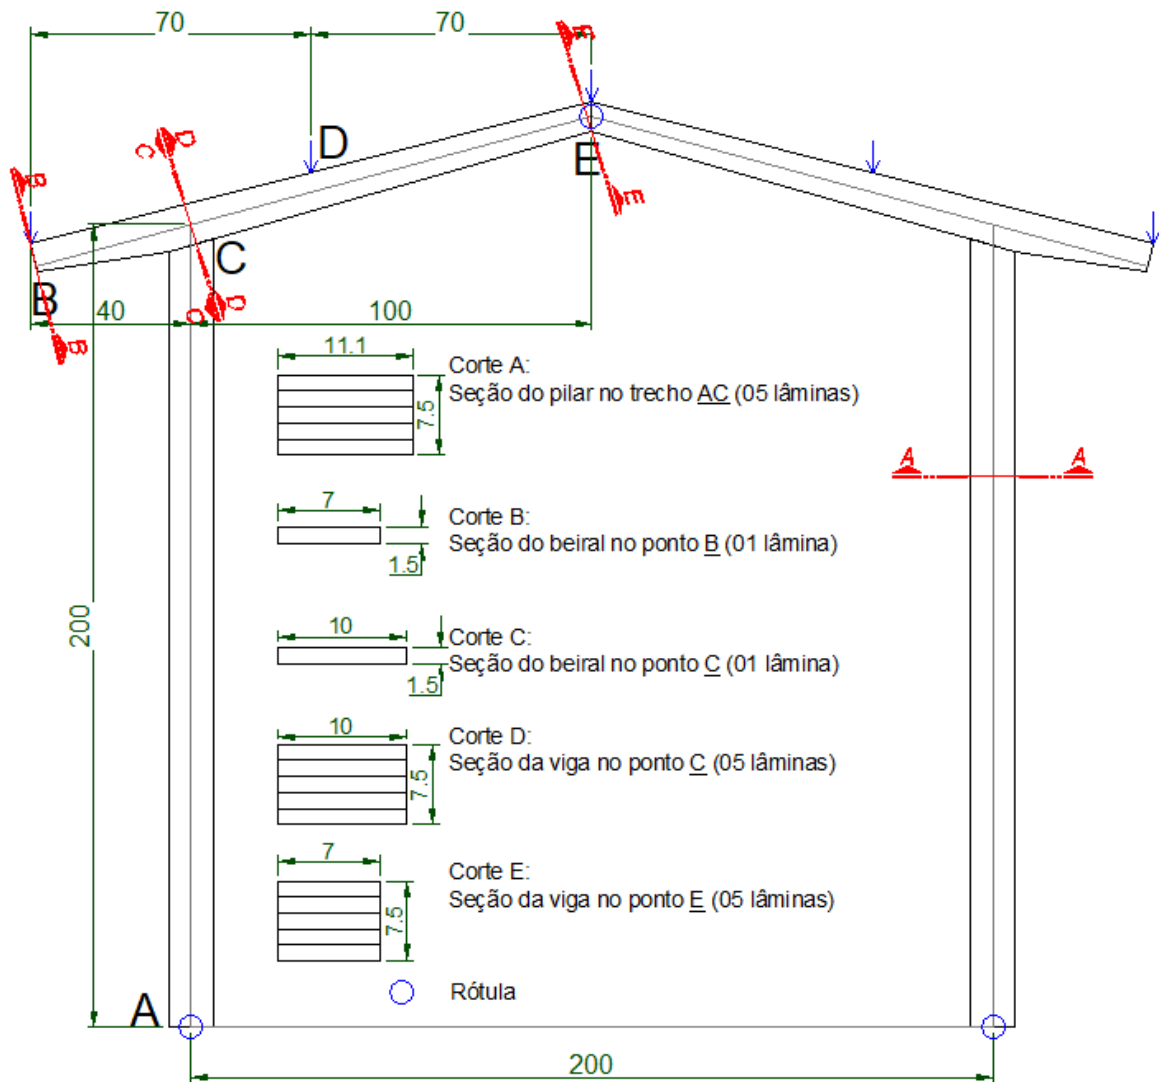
Configuração Geral do Pórtico em Escala Reduzida (Dimensões em cm)
